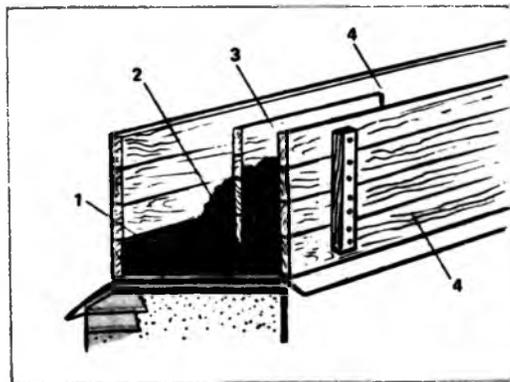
Формирование канала в стене при помощи листа фанеры: 1 — шлакобетон; 2 — засыпка; 3 — фанера; 4 — опалубка
